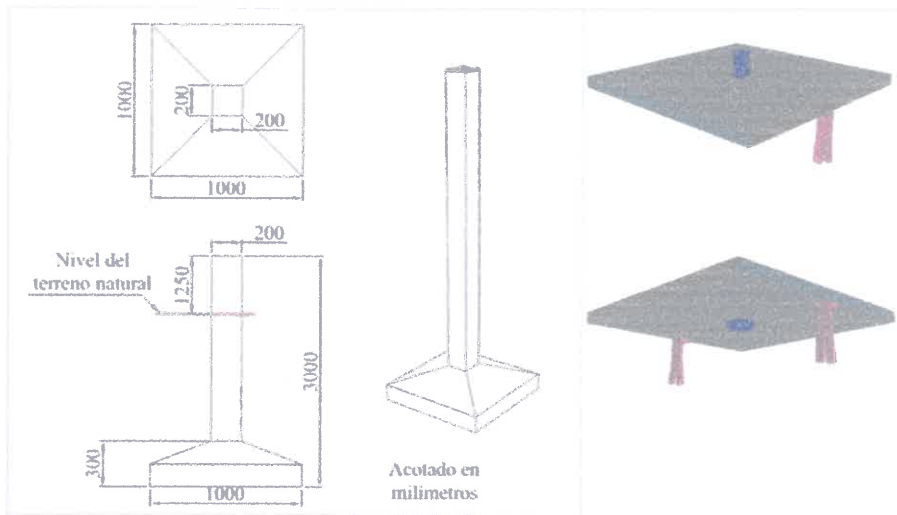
Izquierda: Diseño de pilar utilizado en la base de tres pilares de la Facultad de Ingeniería UNLP. Derecha: Diseño de placa de coronamiento para pilar, en color azul se representa el bulón de 5/8" que sirve para fijar la base nivelante.
